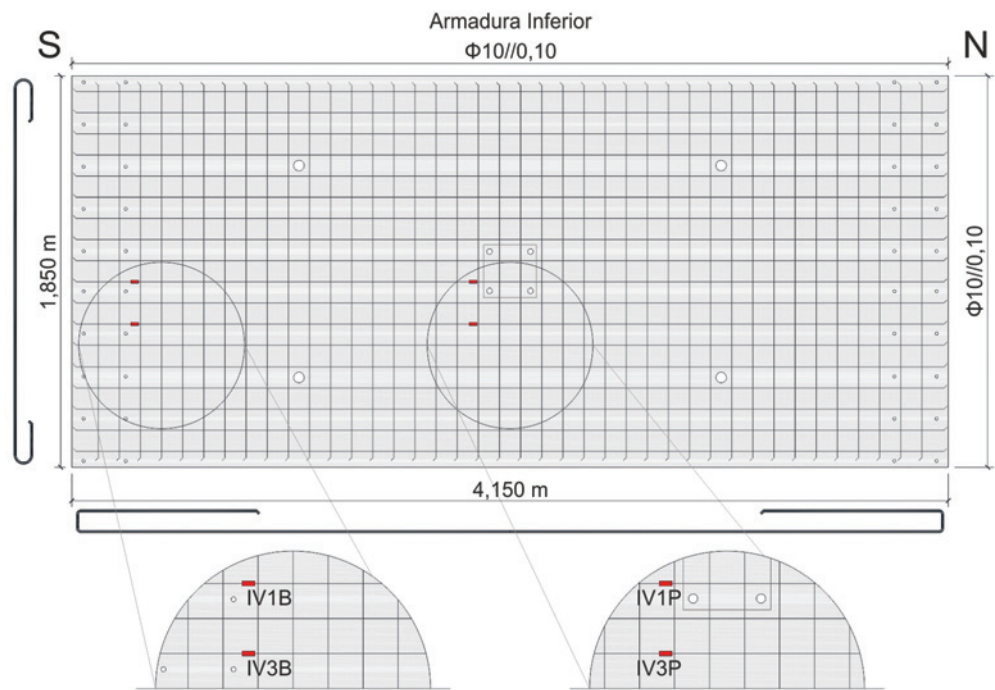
Pormenorização da armadura inferior e respetiva localização de extensómetros em pormenor
